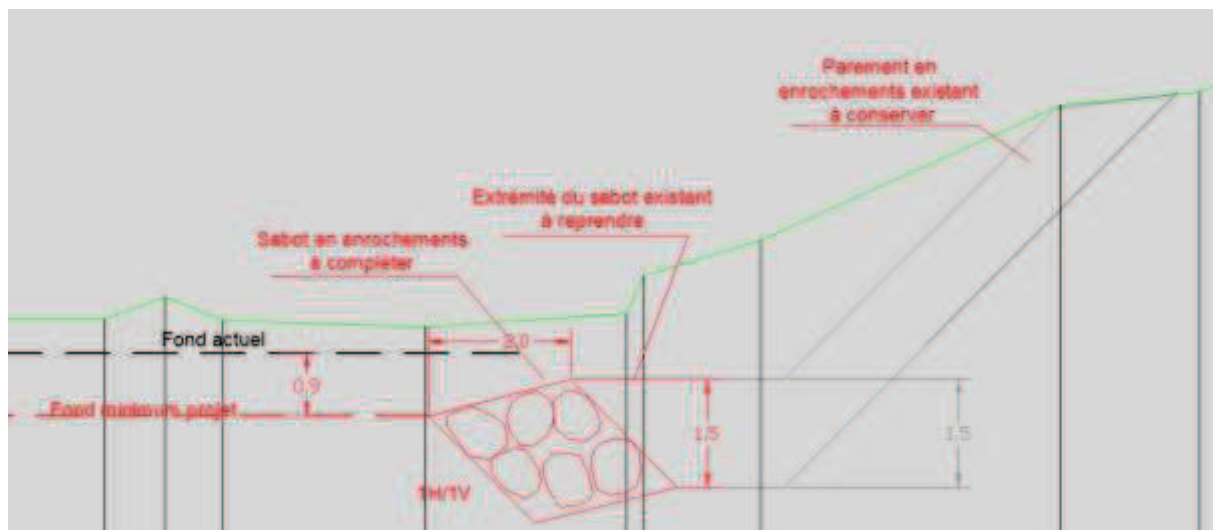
Coupe type des travaux de confortements de berge sur le secteur amont.
